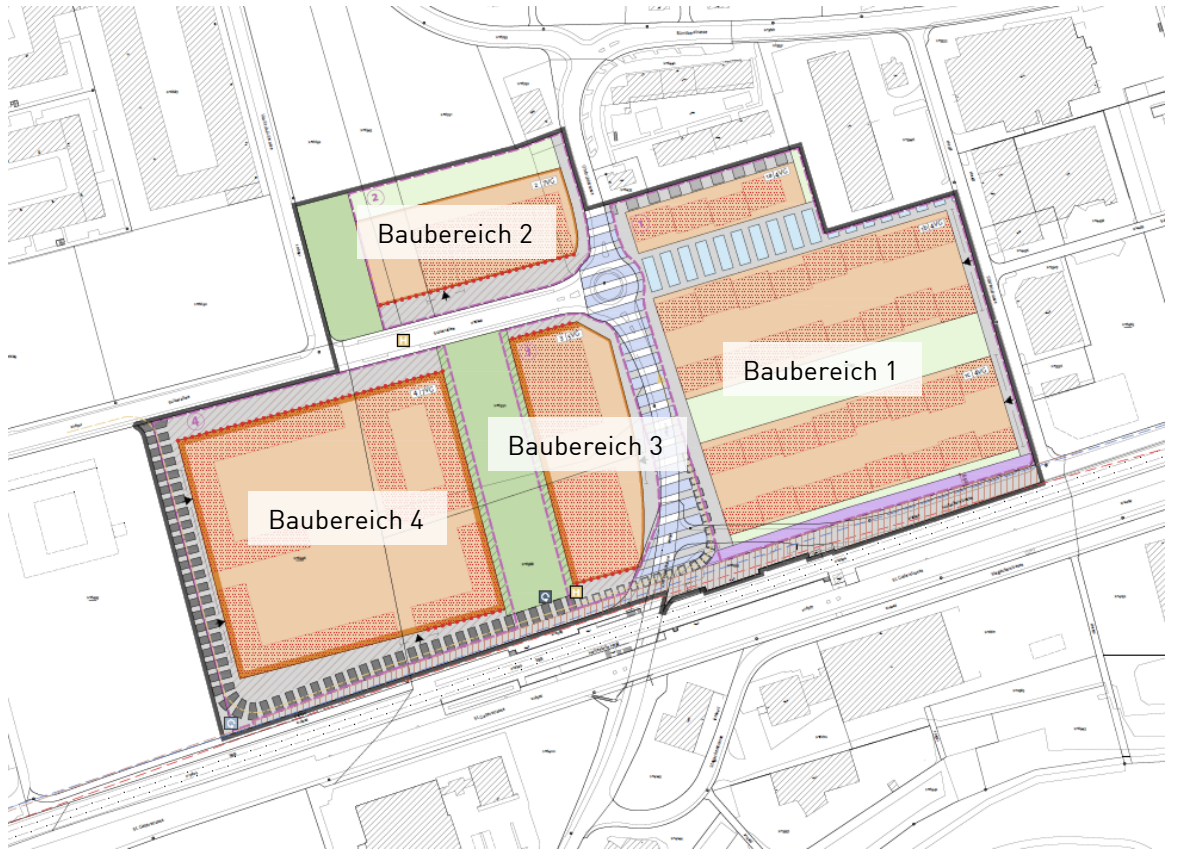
Öffentlicher Gestaltungsplan „Umfeld Hegi“
